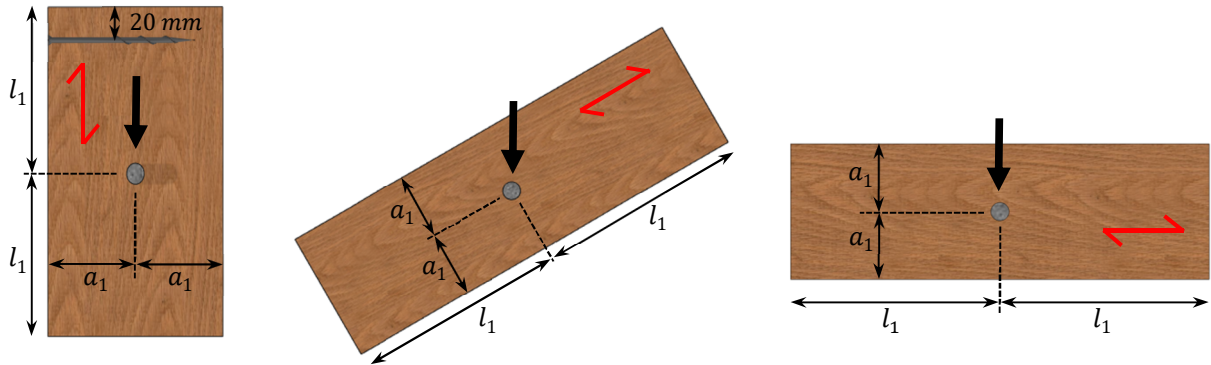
Dimensions des éprouvettes selon EN 383.
